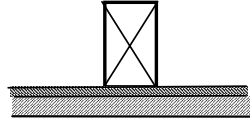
Prinzipaufbau einer Beschwerung bei Holzbalkendecken
